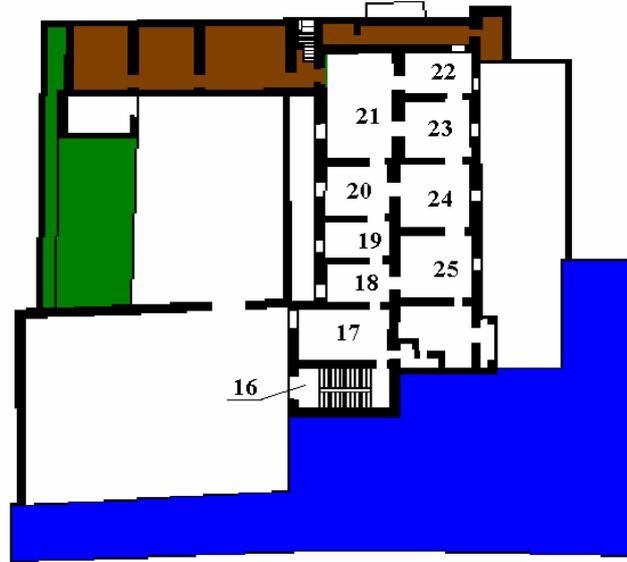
Lo schema planimetrico del primo piano dell'ala ottocentesca
